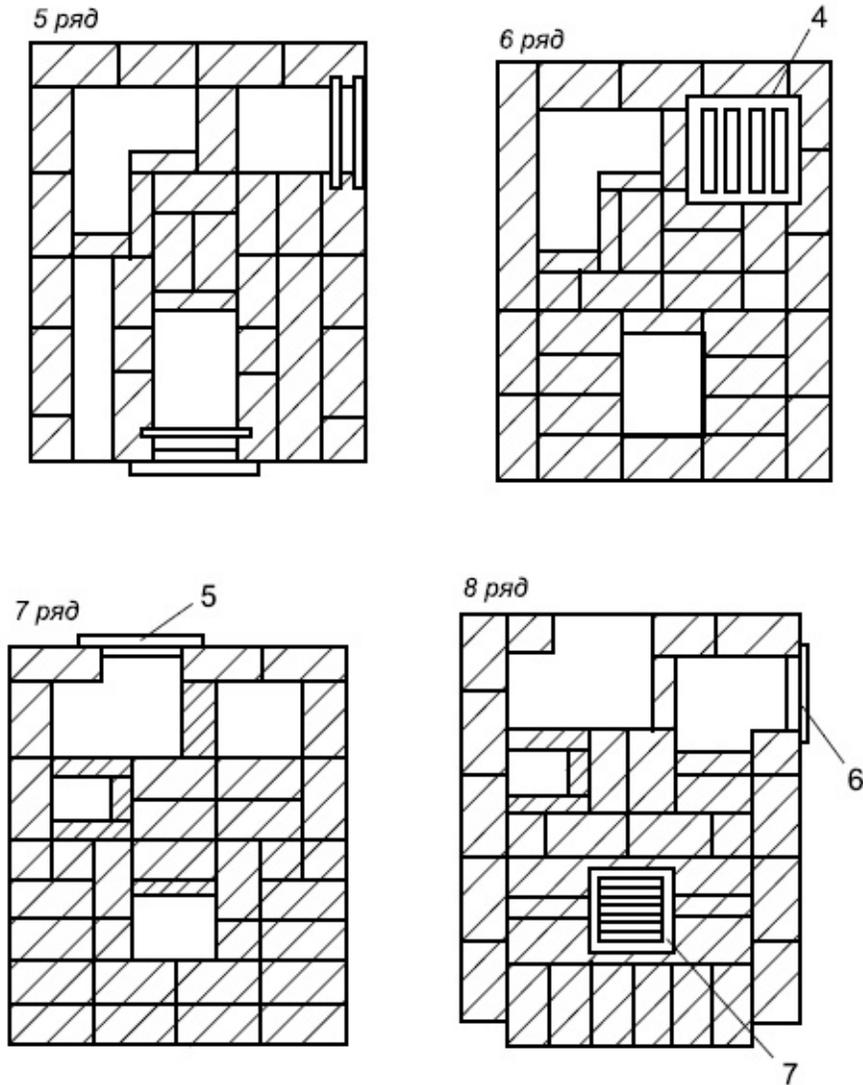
Кладка отопительно-варочной печи с камином (продолжение): 4 – колосниковая решетка печи; 5 – духовка; 6 – дверка топки; 7 – колосниковая решетка
